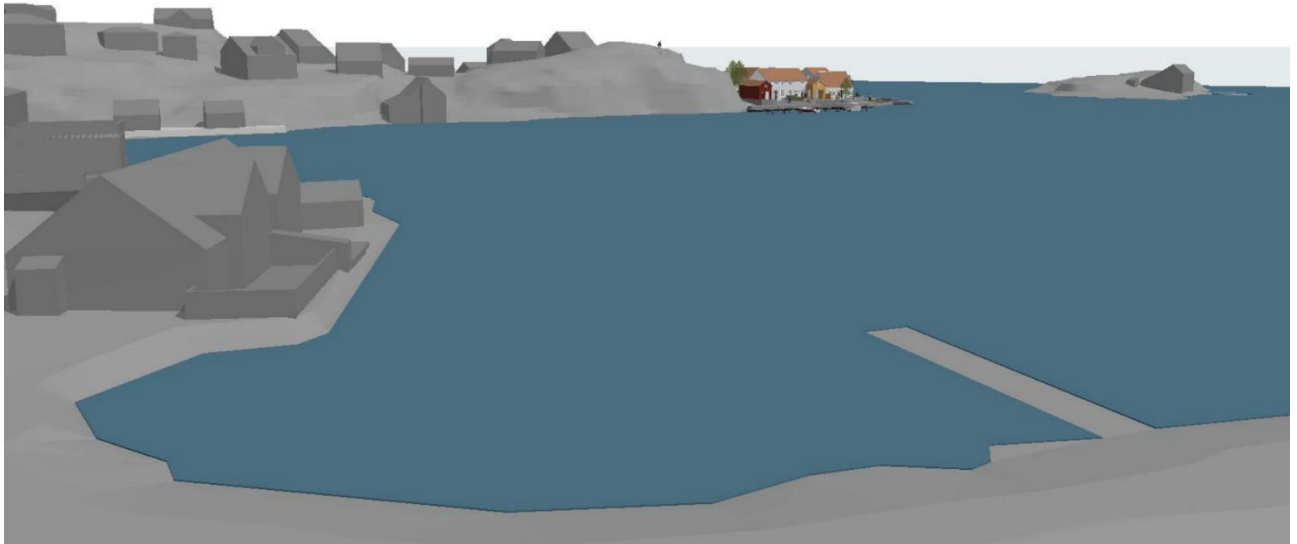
3D illustrasjon av tenkt bebyggelse - sett fra øst. Kilde: Asplan Viak
